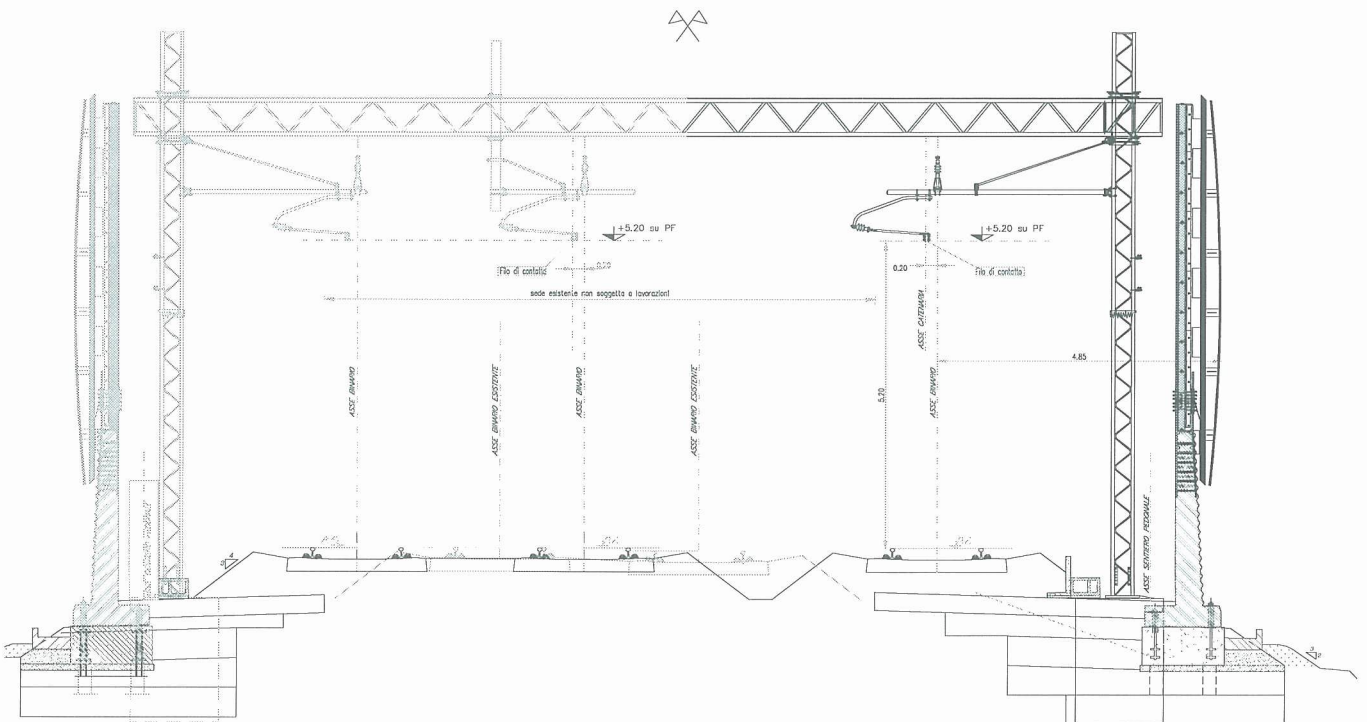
Sezione indicativa sospensioni TE sotto trave MEC e barriera fonoassorbente verticale
